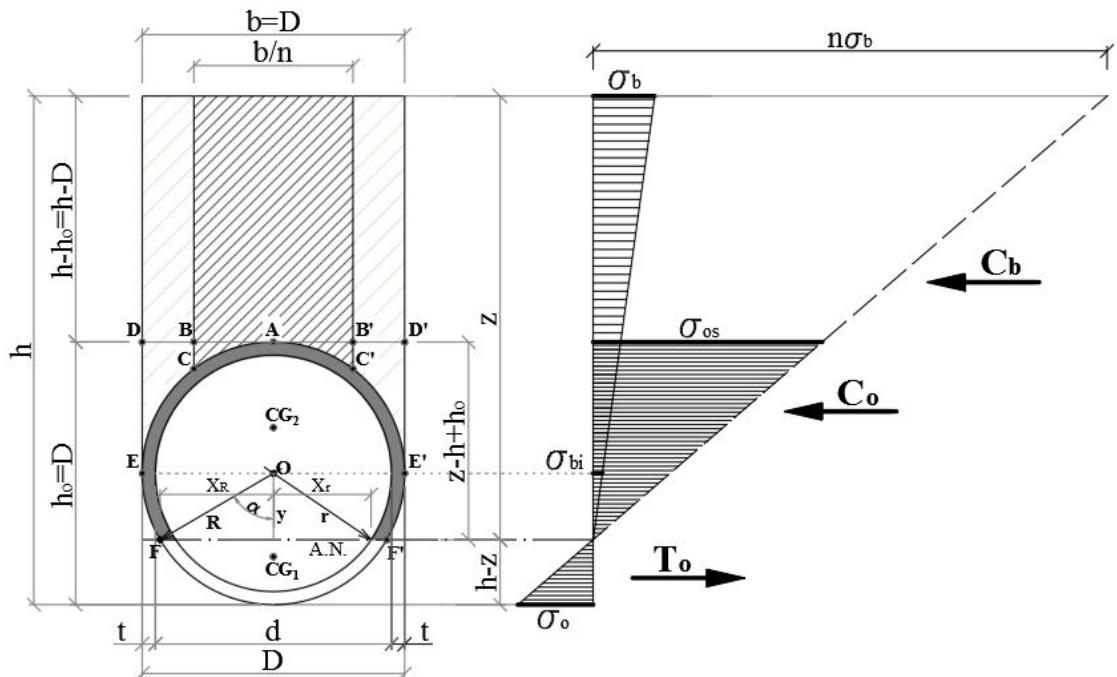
3. Model de calcul pentru structură mixtă oțel-beton cu structura metalică din țevi de oțel tangențiale
